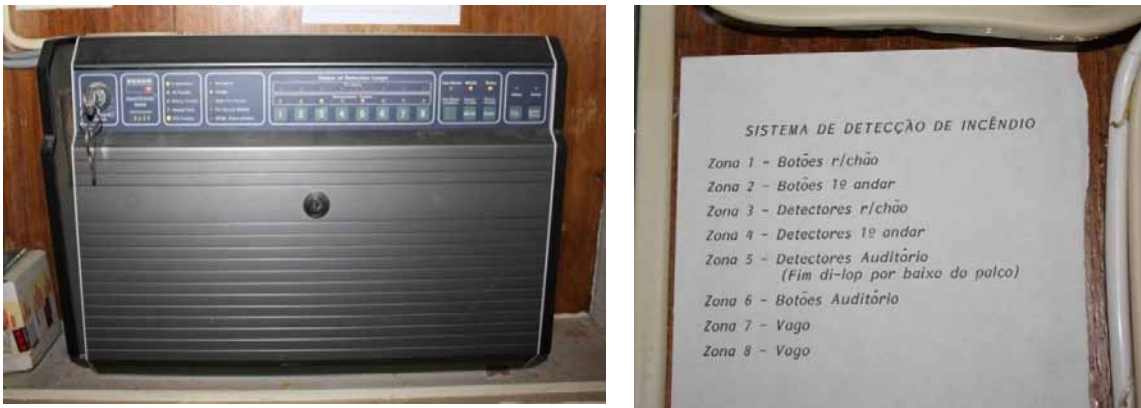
e 4.27 Central de detecção de incêndio e pormenor da divisão em zonas do sistema de detecção
